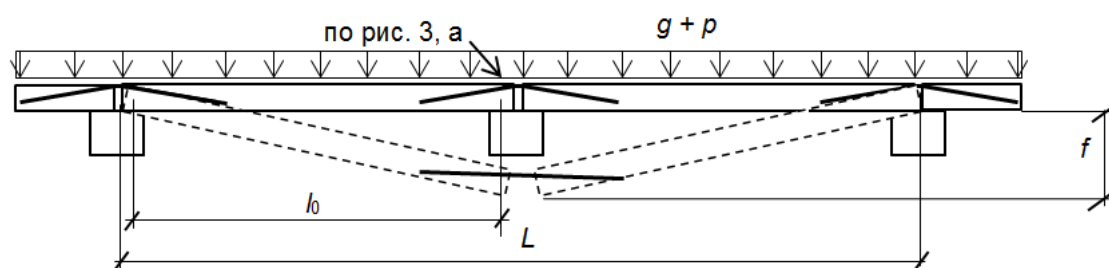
Расчётная схема плит перекрытия при отказе ригеля
